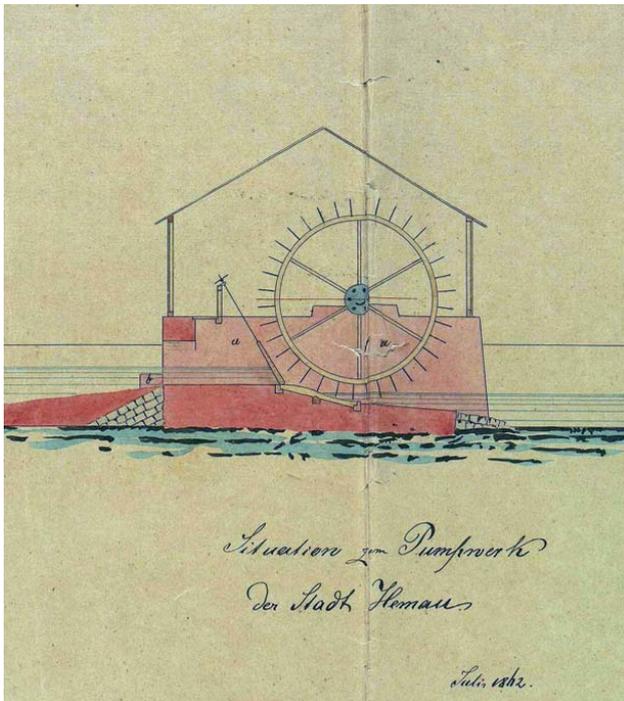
Plan der Firma Cramer-Klett zur Pumpanlage. Ausschnitt
